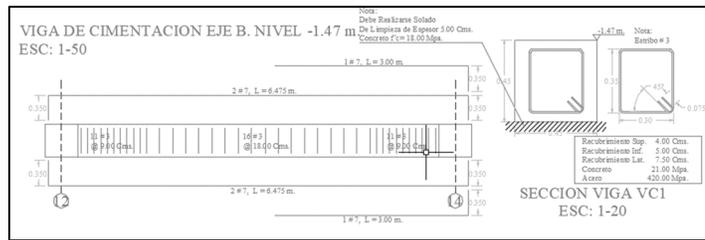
, Despiece viga de cimentación B. Fuente: Constructora Open House.
